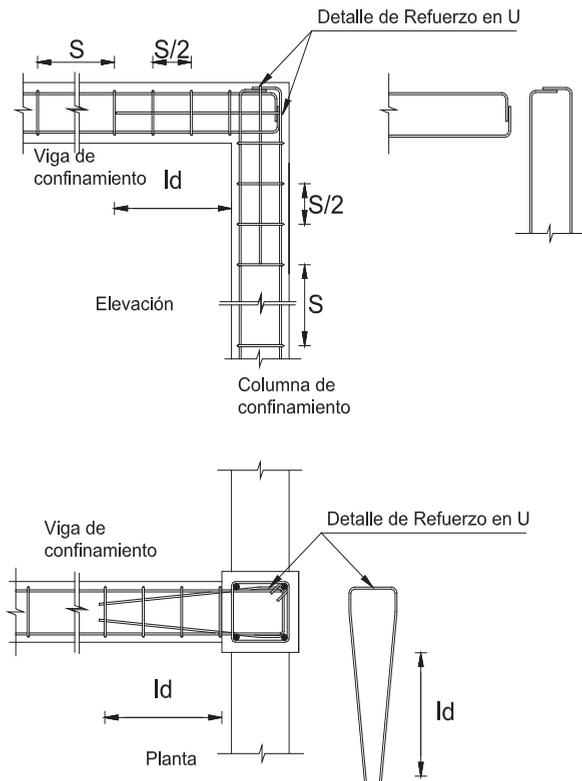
Detallamiento para vigas de confinamiento (riostras)
